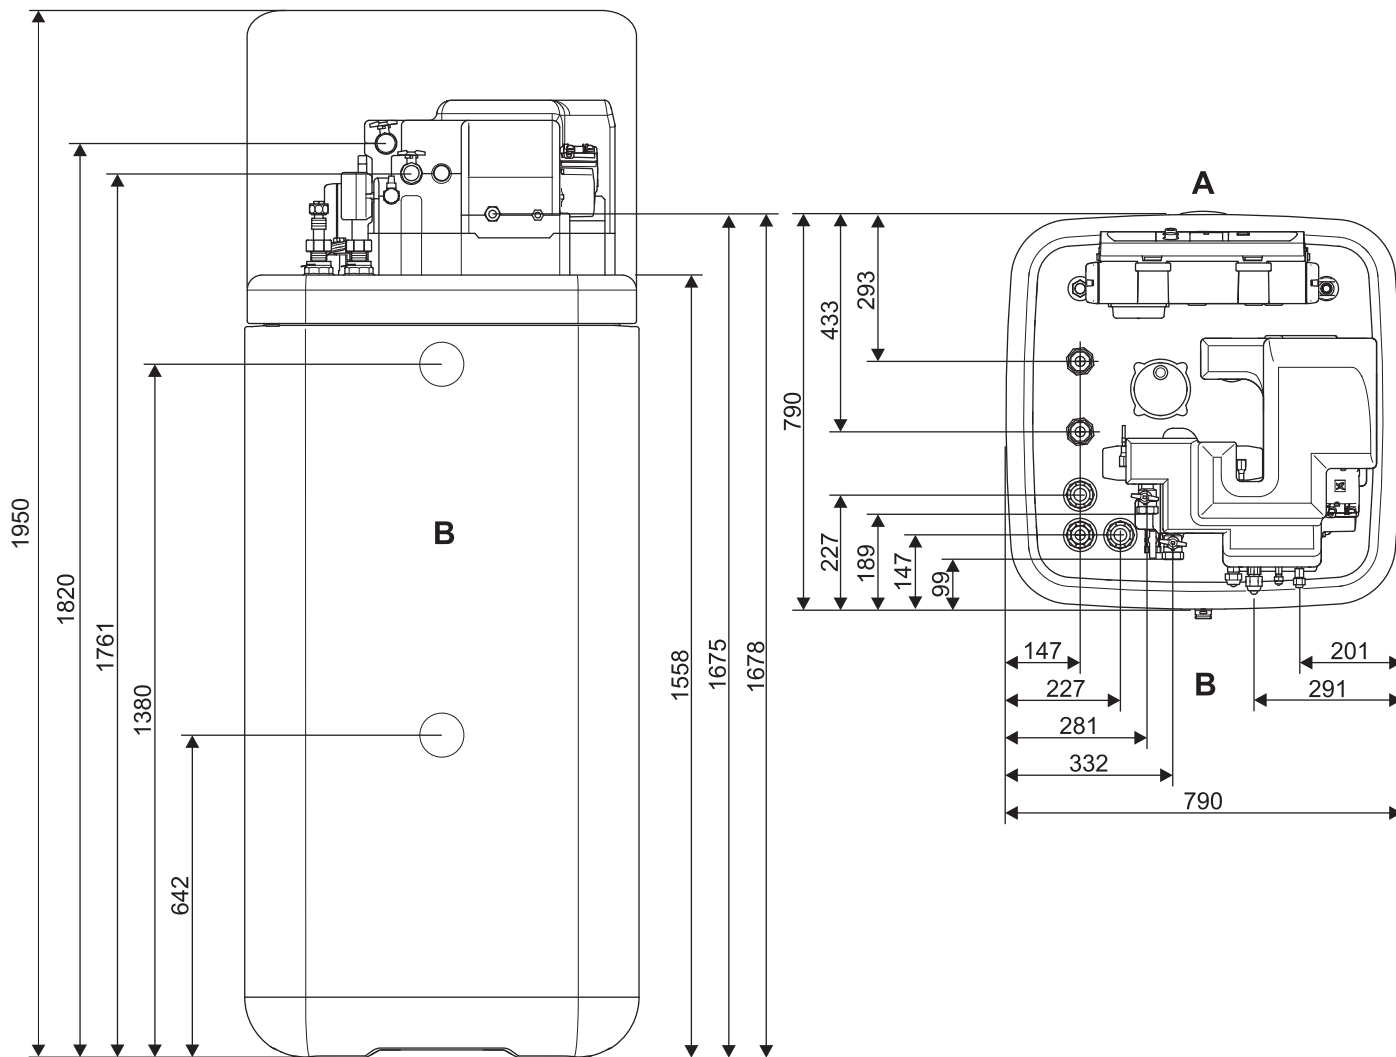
Dimensioni apparecchio interno HPSU compact 508/516 (BIV)
